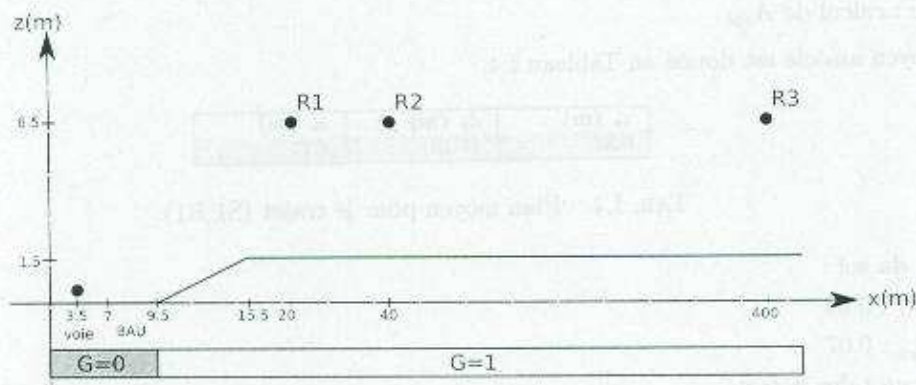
Coupe verticale du site en déblai de 1.5 m.
